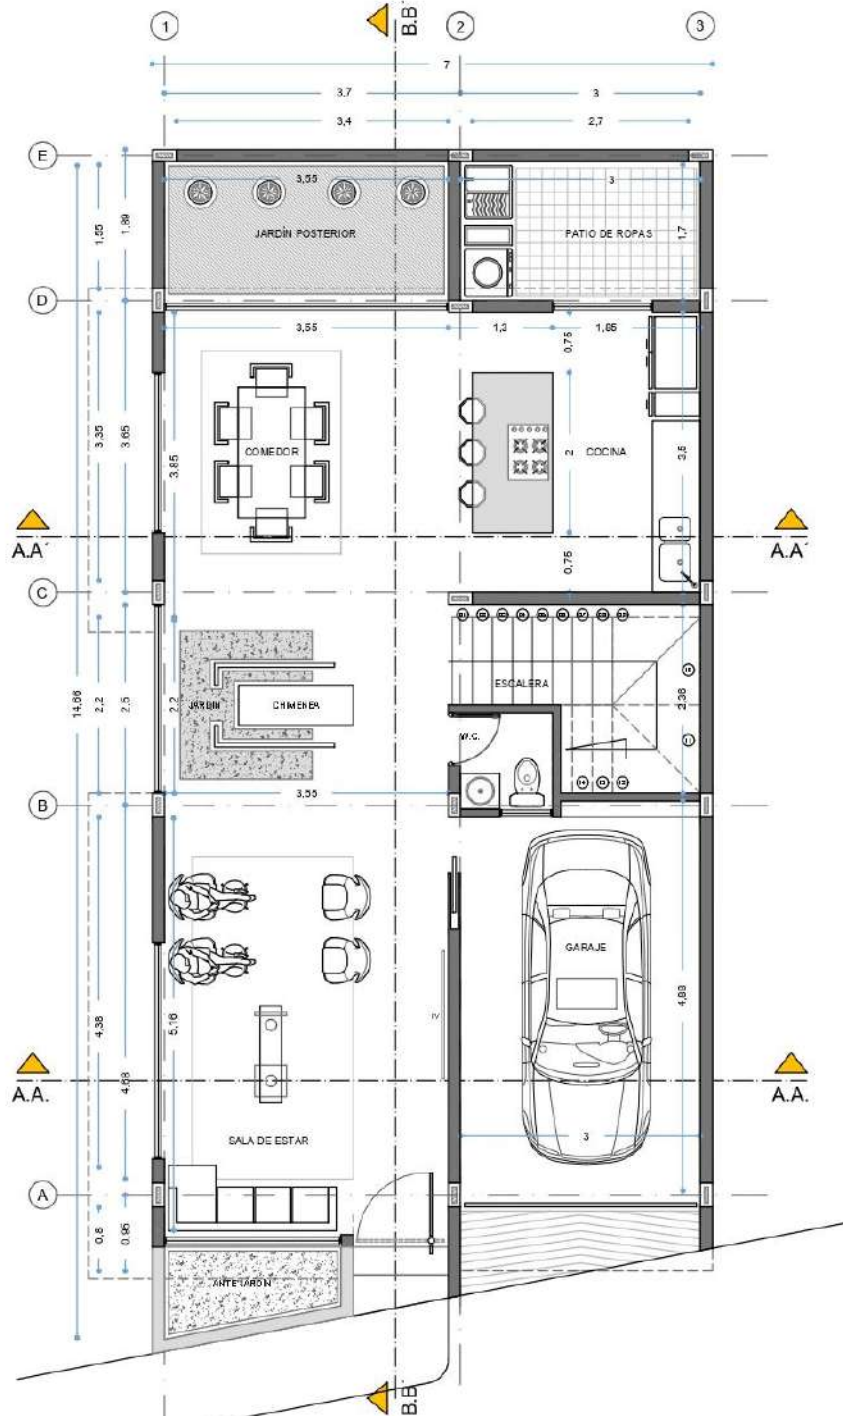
Planta primer piso casa San Sebastián; Fuente: Constructora Pérez y asociados
